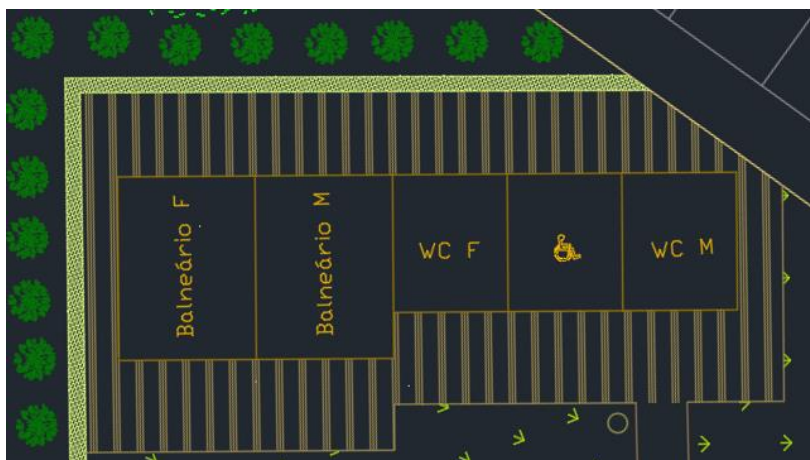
Representação em planta dos balneários e WCs (Fonte: AutoCad Civil 3D)
